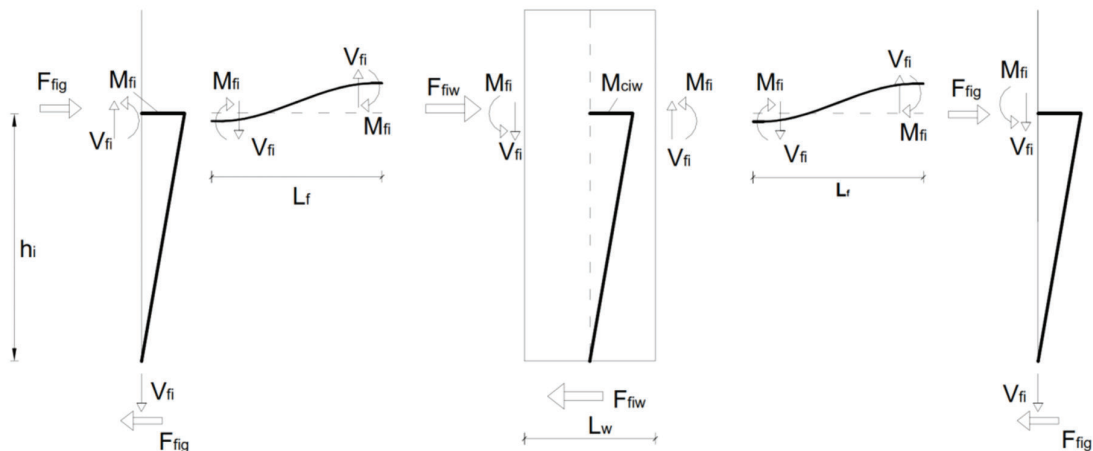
ESTADO DEFORMADO DE EDIFICIO CON MUROS CON UNA ROTULA PLASTICA DESARROLLADA EN LA BASE DEL MURO
